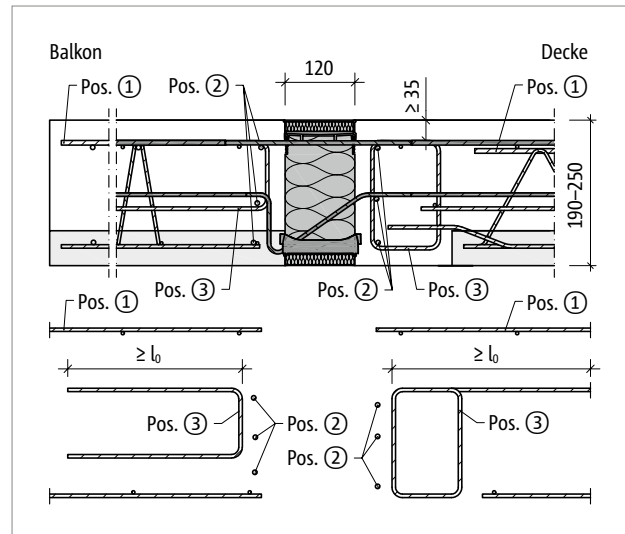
Schöck Isokorb® XT Typ KL-F: Bauseitige Bewehrung bei Balkonplattendicke  $h = 190\text{--}250\text{ mm}$
